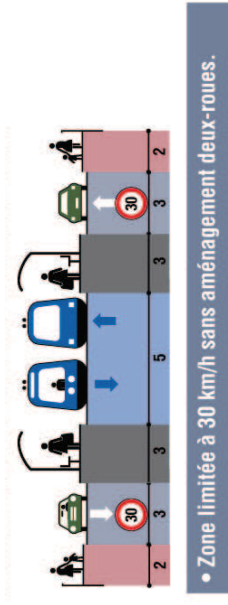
Profils en station – Profils à double sens avec extension d'emprise
